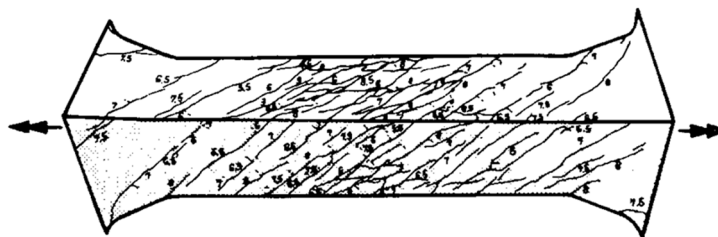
Rissbild eines torsionsbeanspruchten, bewehrten Stahlbetonstabes aus [2]
